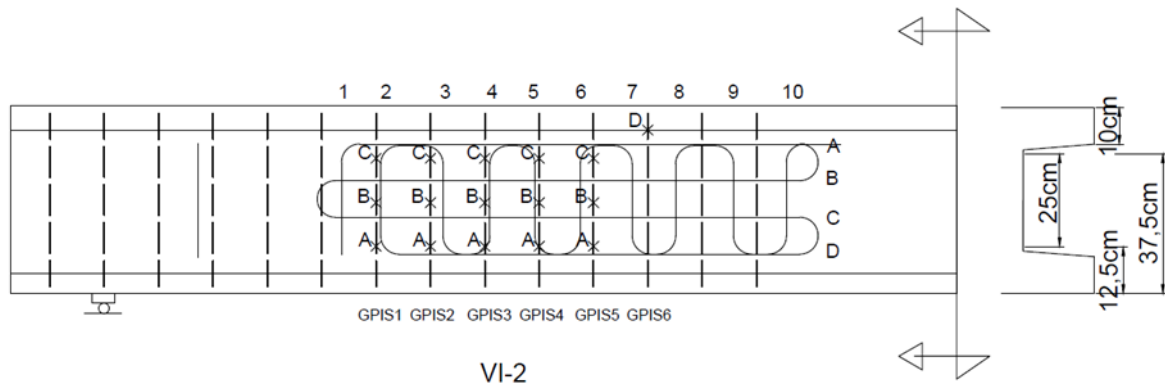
Ubicación de galgas y secciones del SFOD1 para el ensayo de cortante de la viga I-2
